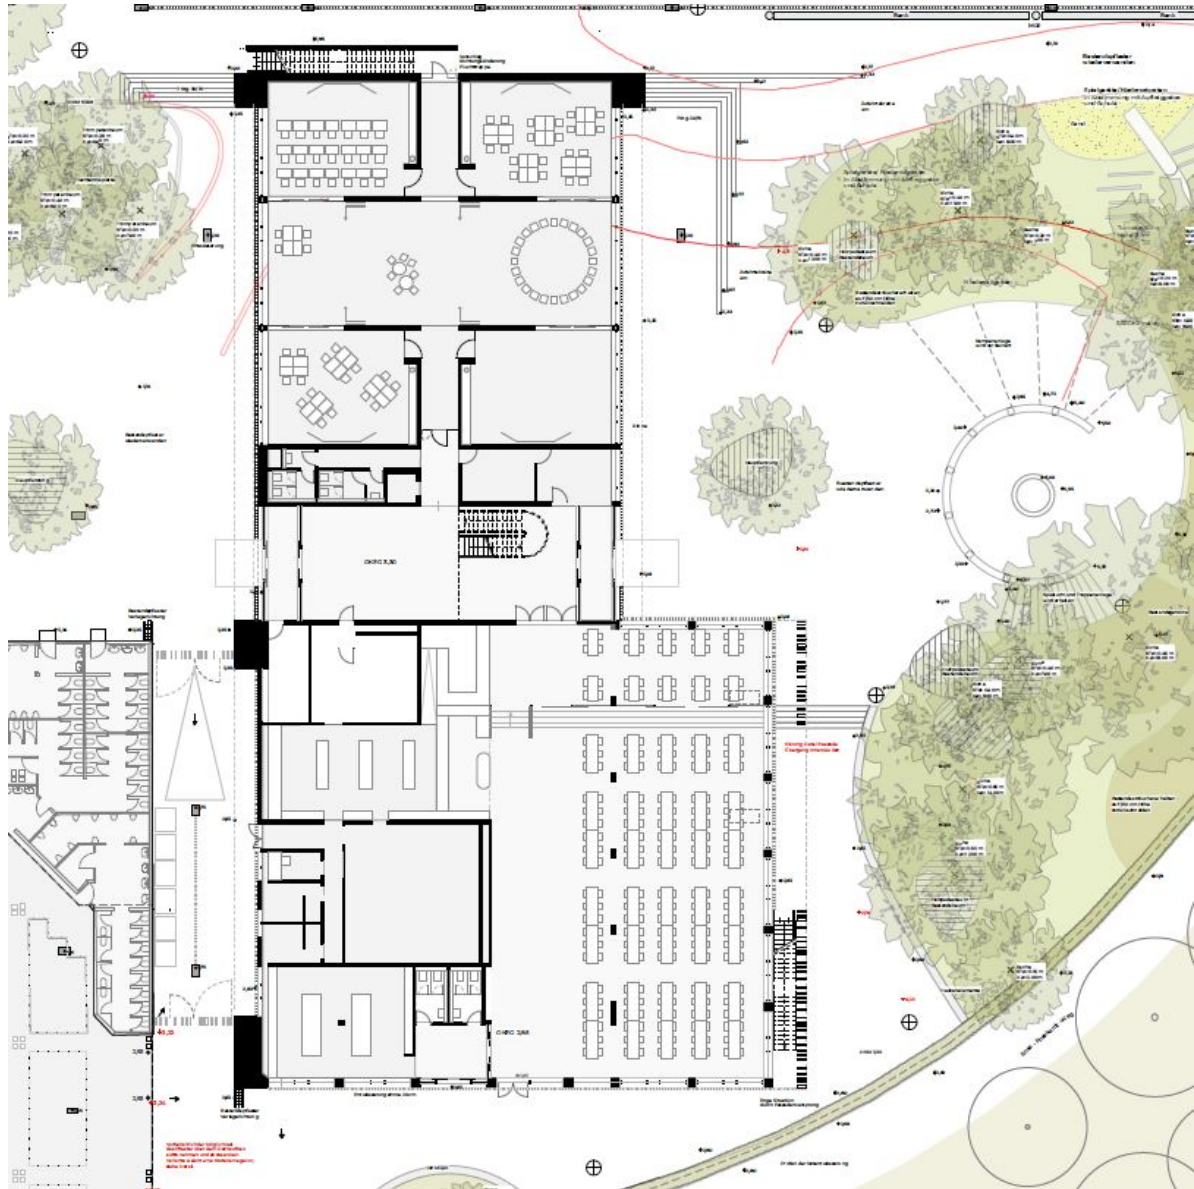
Lageplan Neubau einer 2-zügigen Grundschule mit Mensa
